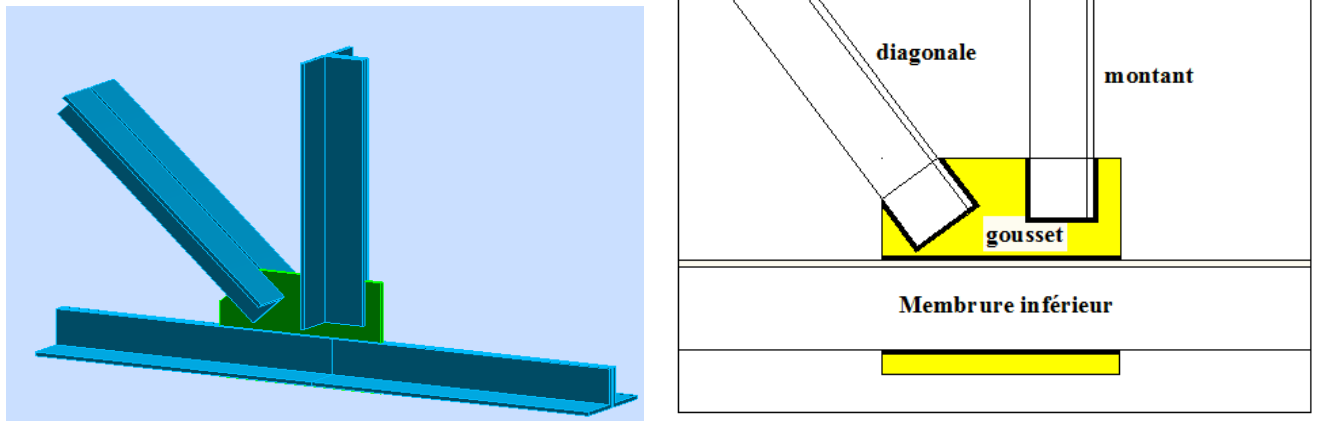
Détail assemblage Gousset- éléments de la ferme
